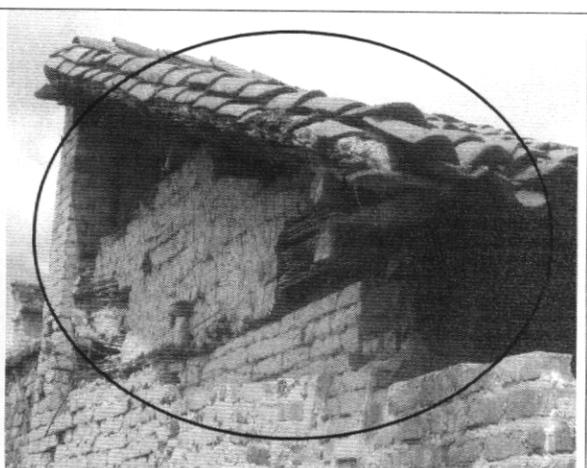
Apoyo de cubierta y cubierta en malas condiciones
